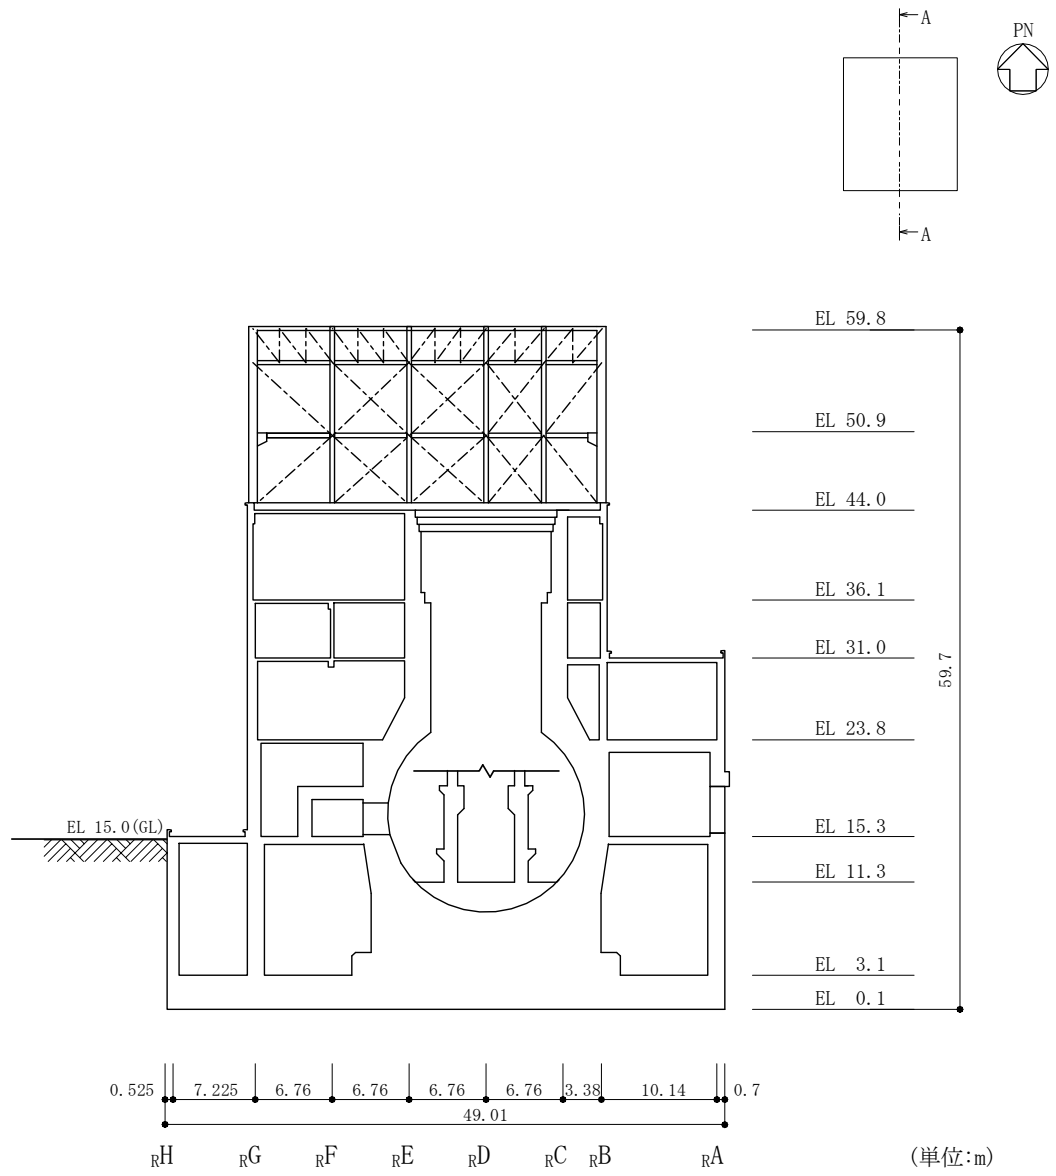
(1) 1号機原子炉建物の概略断面図 (A-A断面, NS方向)
